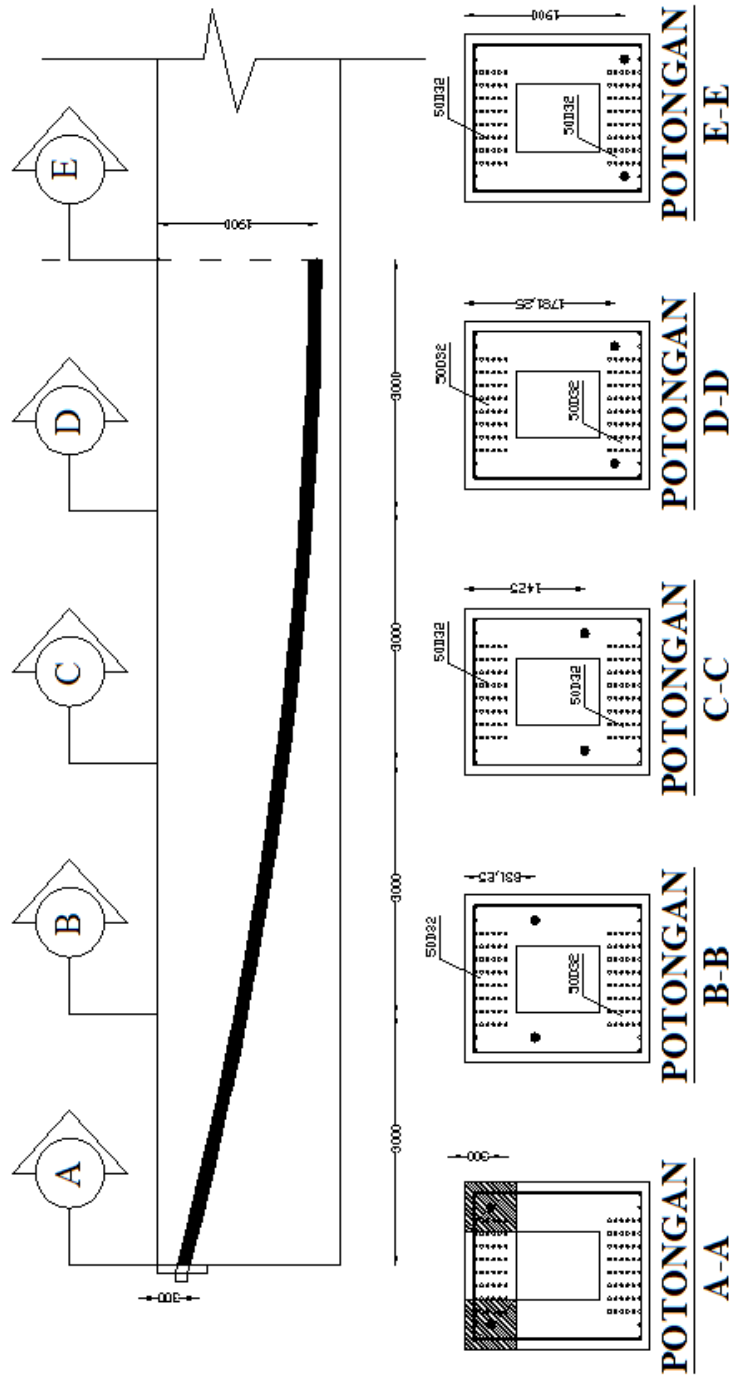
Detail Pilecap Struktur Portal dengan Tumpuan Jepit
